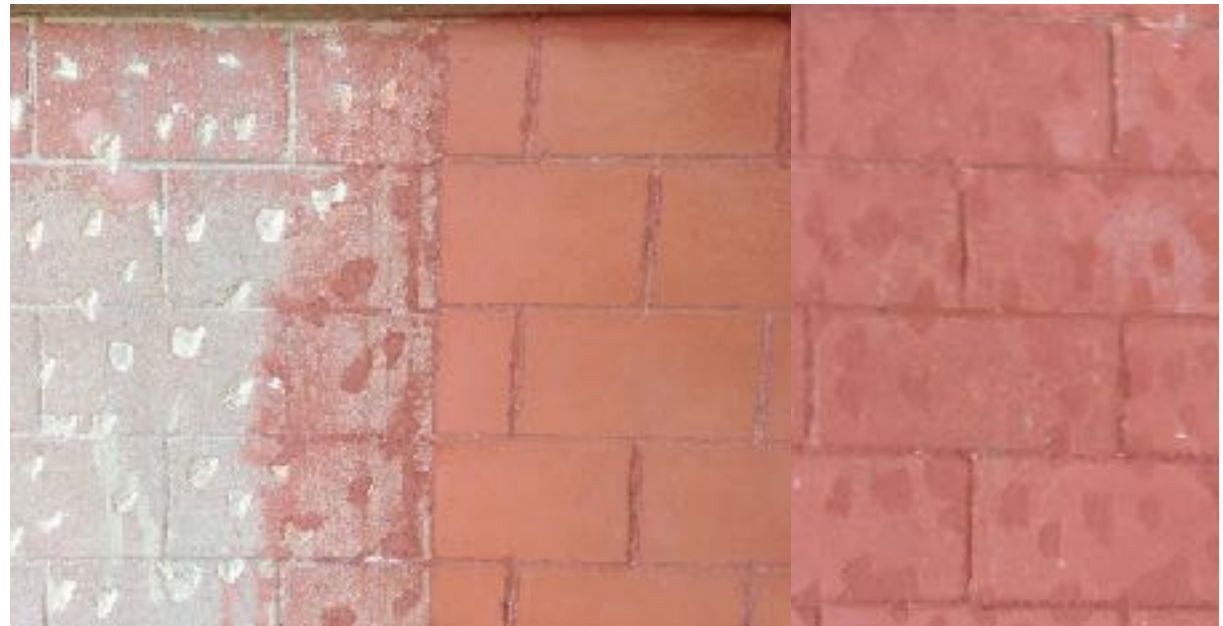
FOTO EXTERIOR TORRE SAGRERA PROYECTO
